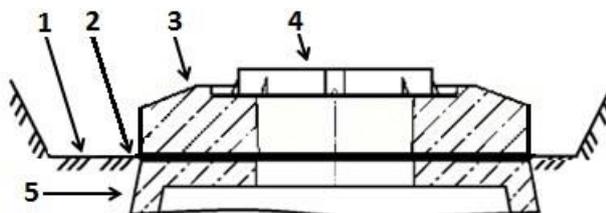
Плита ОП-4 установлена на перекрытие колодца ККСр-4.
